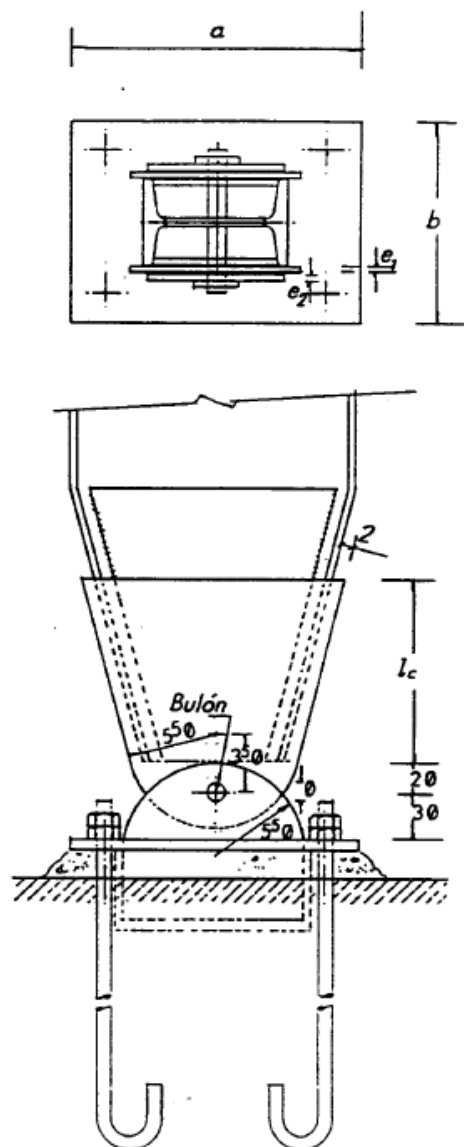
Placa de ancoratge entre pilar i sabata de cimentació
